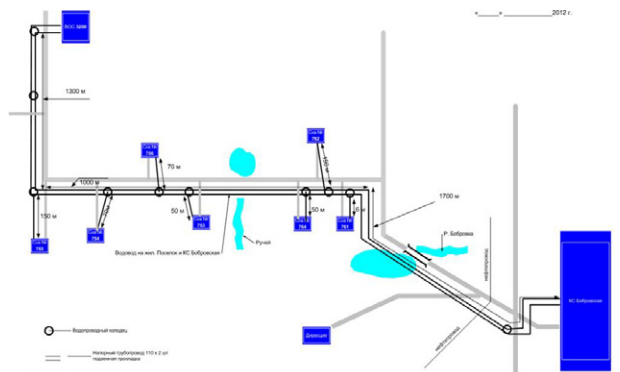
Схема прокладки внеплощадочных сетей водопровода
